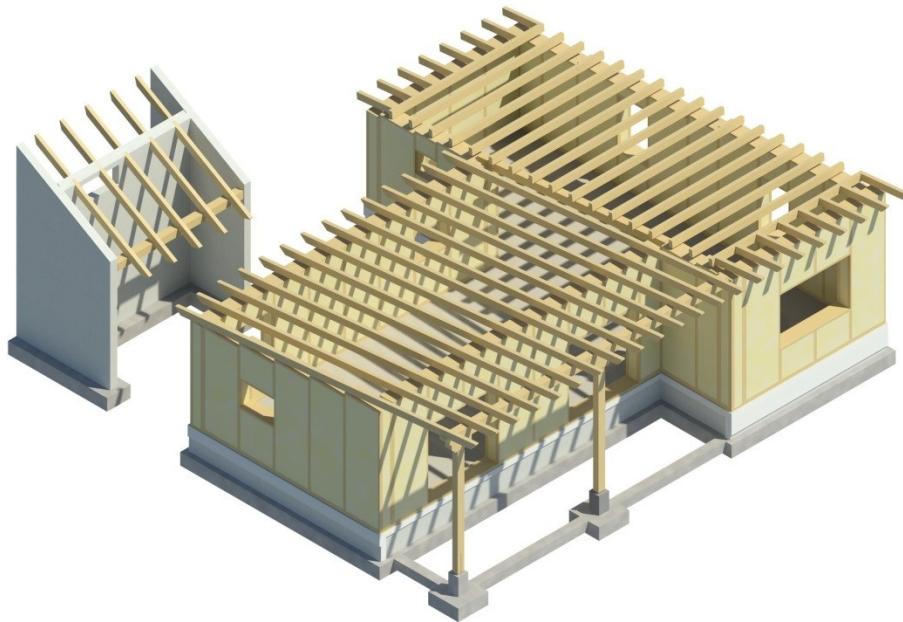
3D cimentación, cerramiento y cubierta. 2016. Creación propia.
